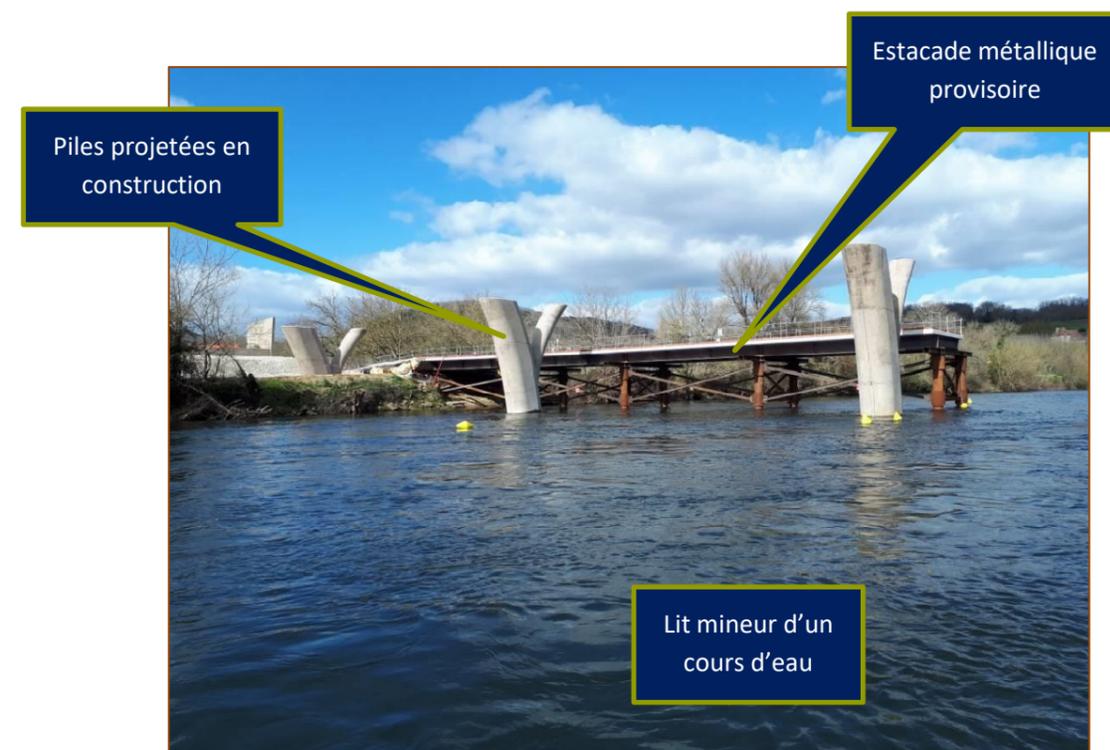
Exemple de construction de piles en rivière grâce à une estacade métallique
